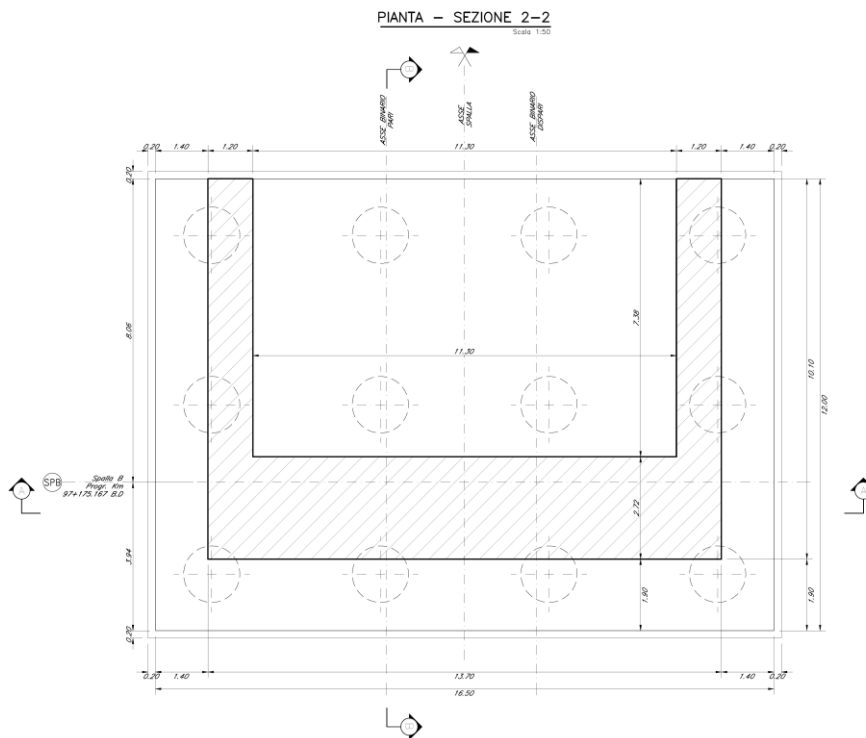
Vista in pianta della spalla B – Lato Ventimiglia.
